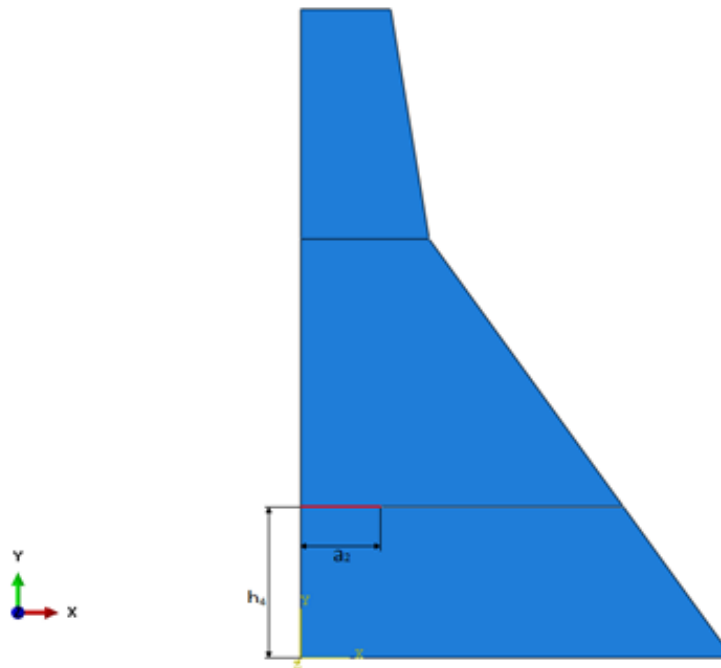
Esquema de dimensiones de grieta sin sellar.
